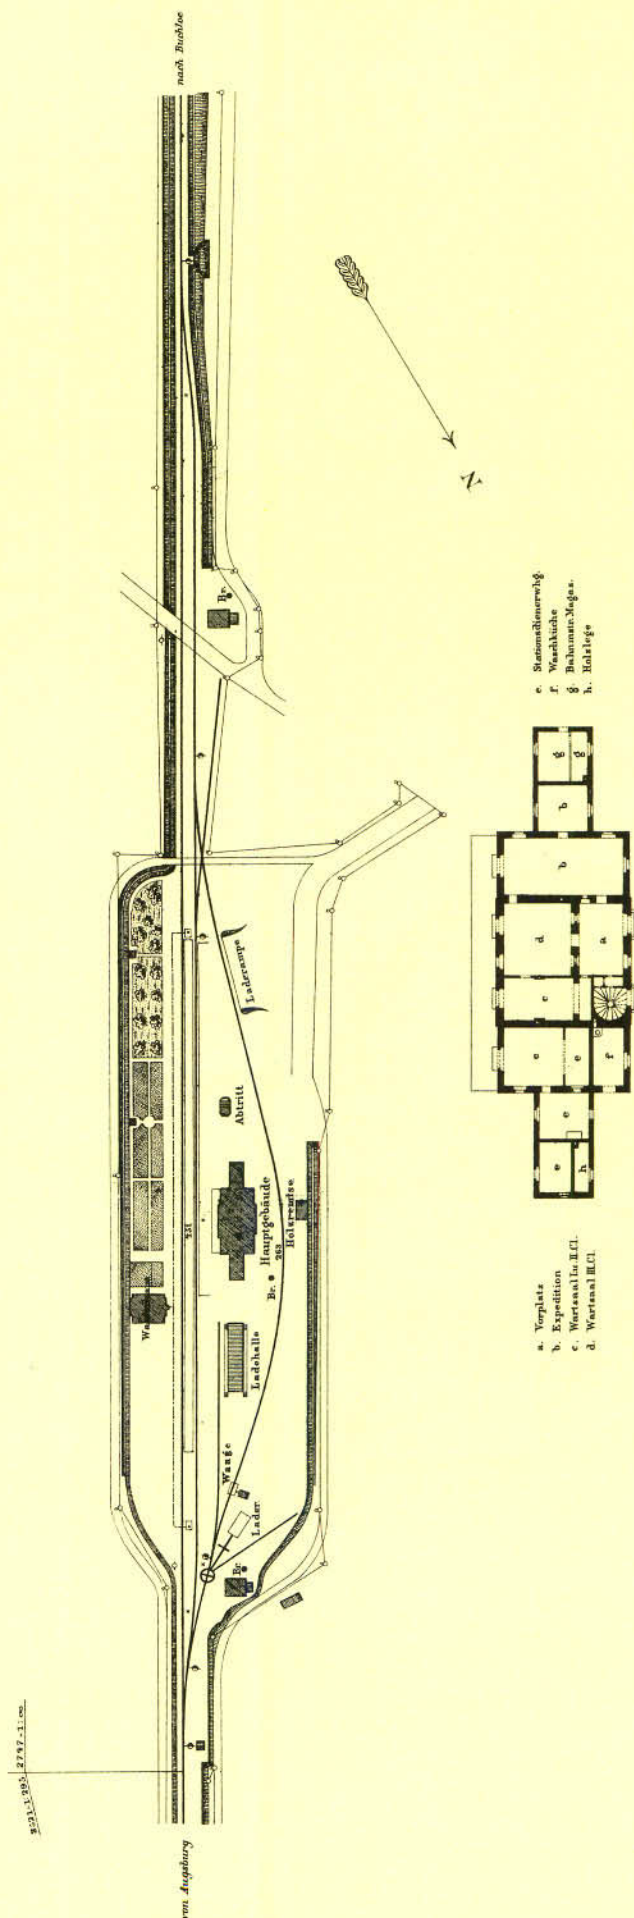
(oben): Bescheidener als Inningen konnte eine Station an einer eingleisigen Hauptbahn damals kaum aussehen: Hauptgleis mit Ausweichgleis, Anschlußgleis zur Ladehalle und Stumpfgleis mit Waage.
